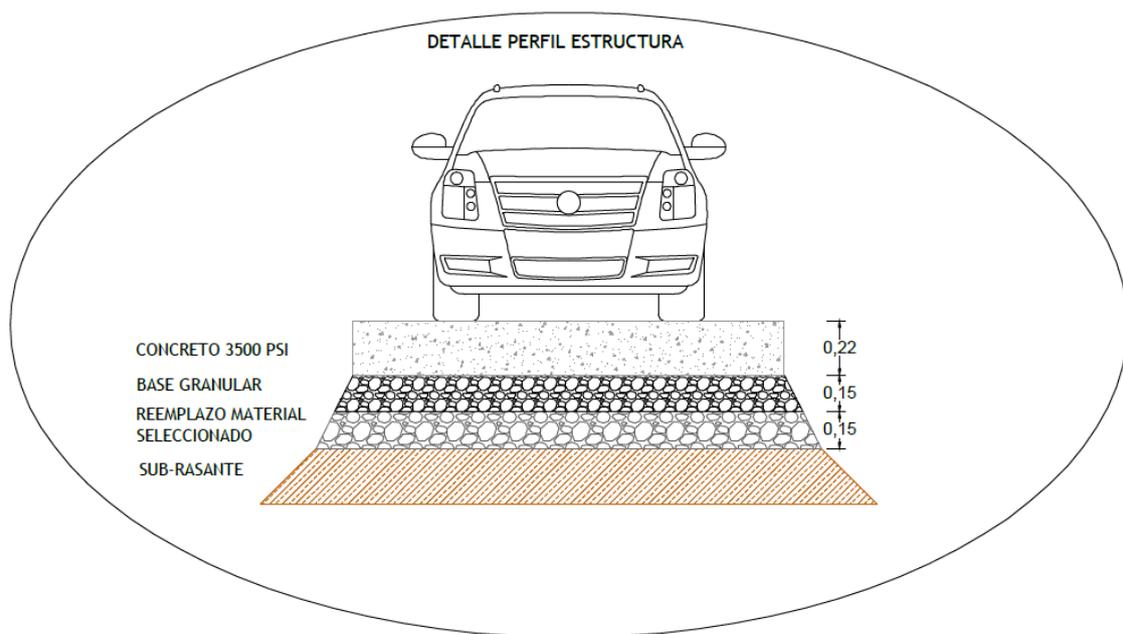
Detalle del perfil de la estructura de pavimento. Elaboración Propia
